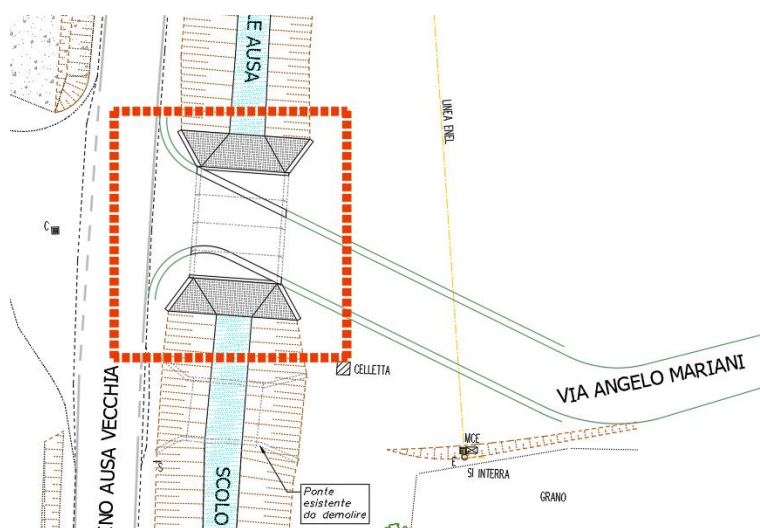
Planimetria nuovo attraversamento via A. Mariani
